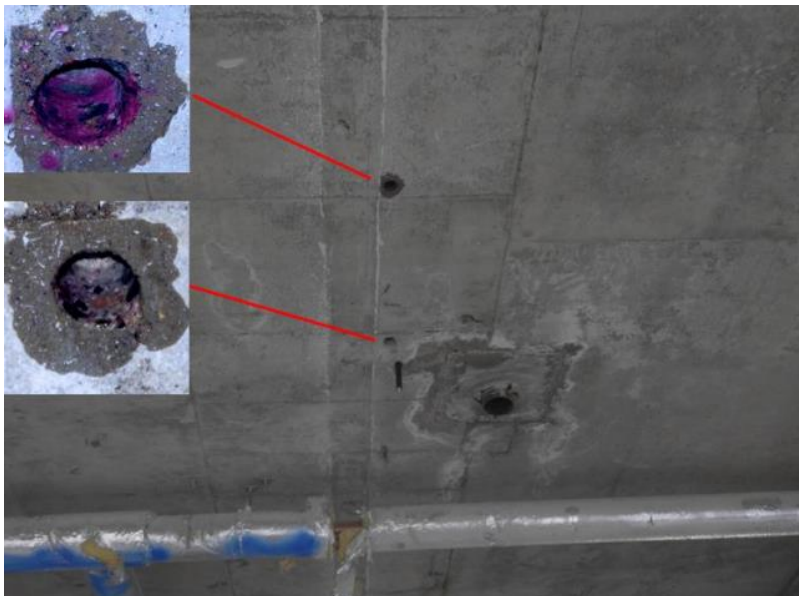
Rakenneavauksesta otettu poranäyte. Poranäyte kokonaan karbonatisoitunut. Raudoituksen ympärillä havaittavissa ruostetta. [8]
